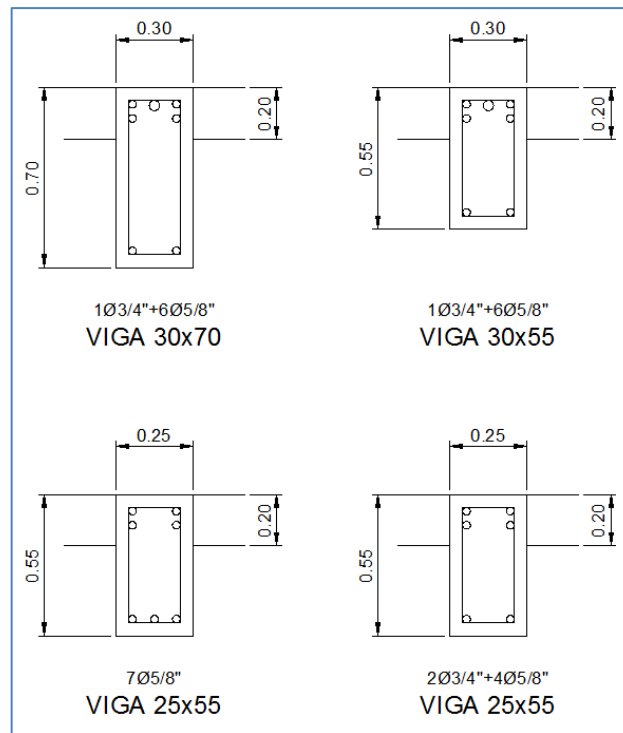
Detalle del refuerzo de las vigas (Edificio 780 actual)
